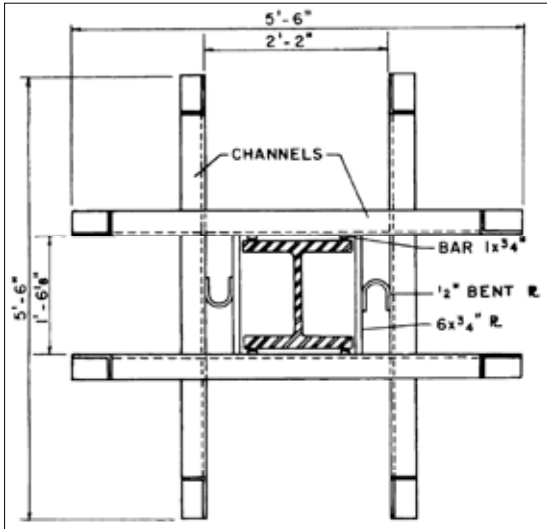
Detalle de la conexión entre el anillo de forjado y el pilar<sup>48</sup>
